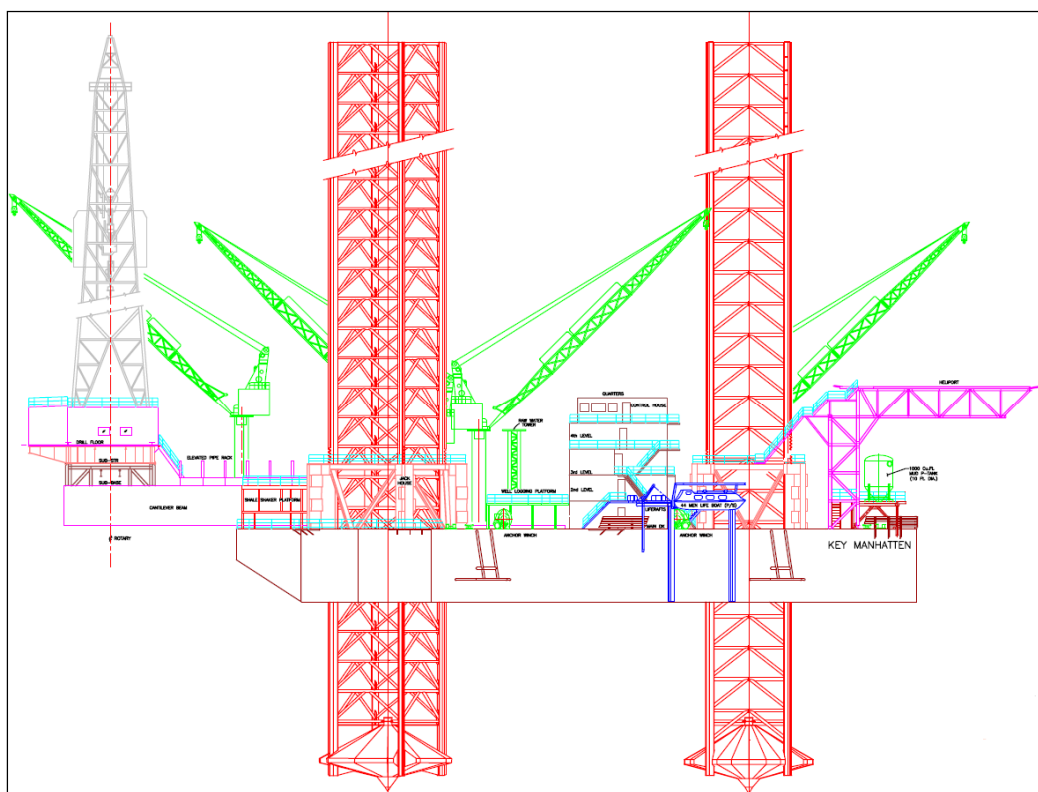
planimetria Impianto Jack-Up Drilling Unit (GSF Key Manhattan - Vista laterale del piano motori, pompe, vasche)
